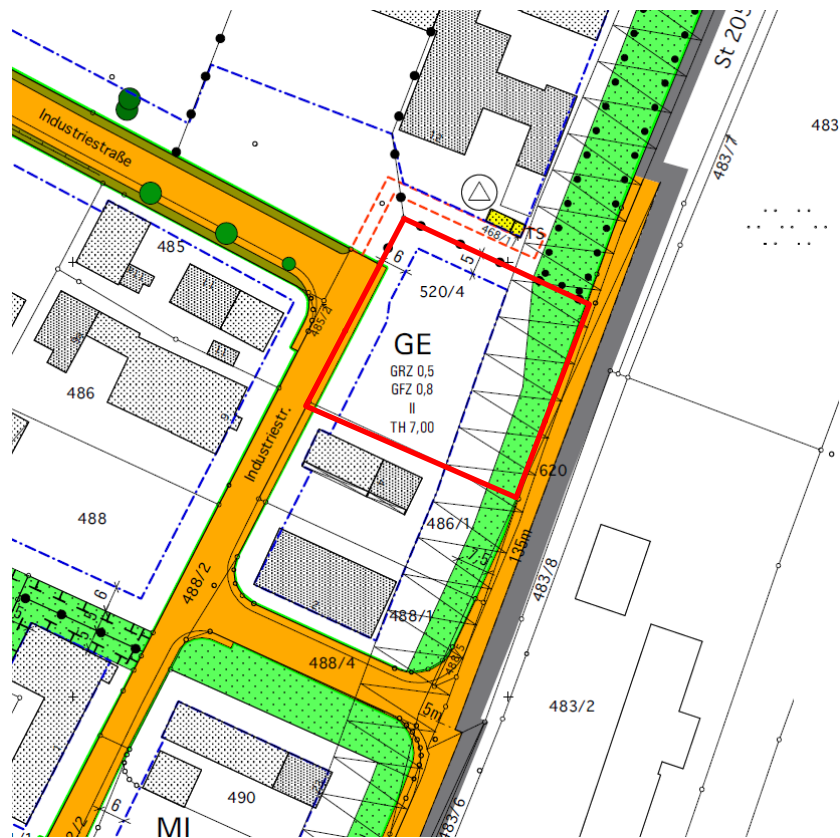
Ausschnitt aus dem wirksamen Bebauungsplan mit Lage 6.Änderung (rot), ohne Maßstab
